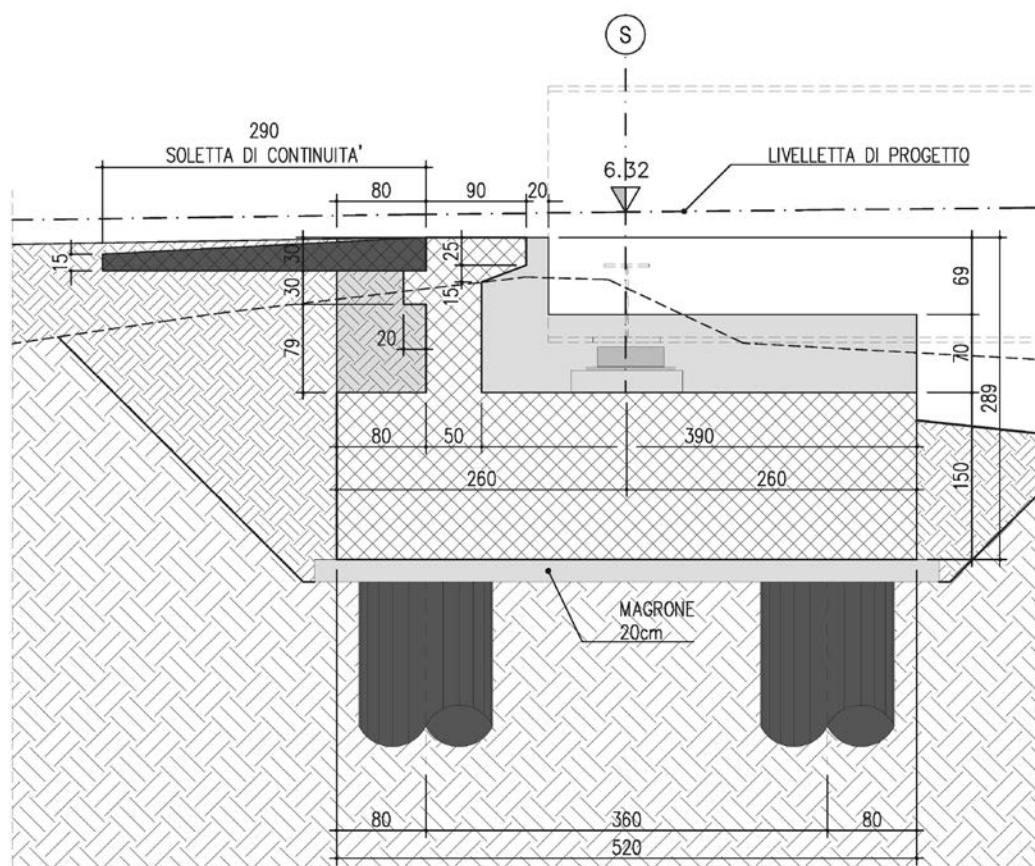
Ponte sul canale Marzenego –Sezione spalla
